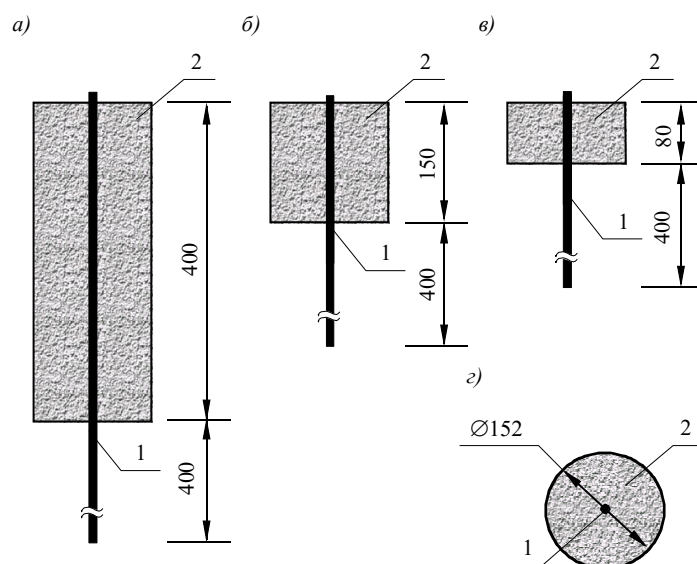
Конструкция опытных образцов : а) длинный образец; б) средний образец; в) короткий образец; г) поперечное сечение образца; 1 – арматурный стержень; 2 – бетонная обойма
